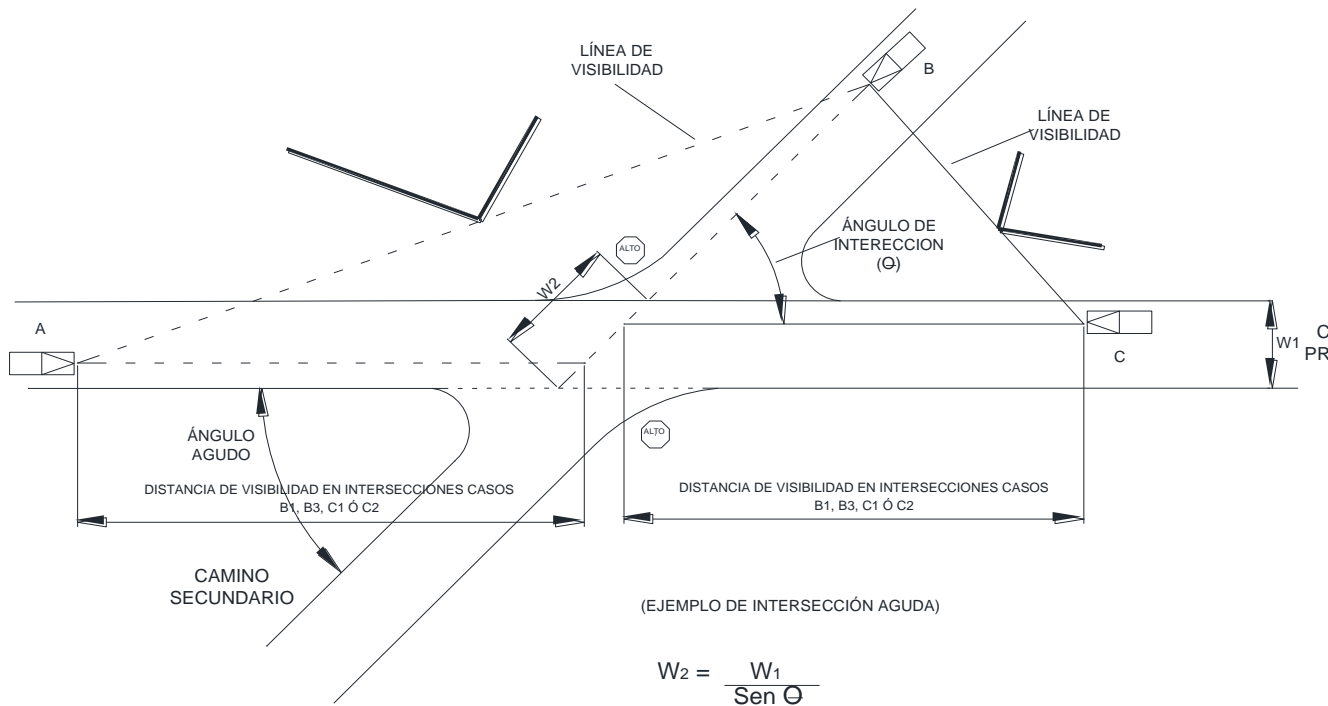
triángulo de visibilidad en intersecciones esviajadas
